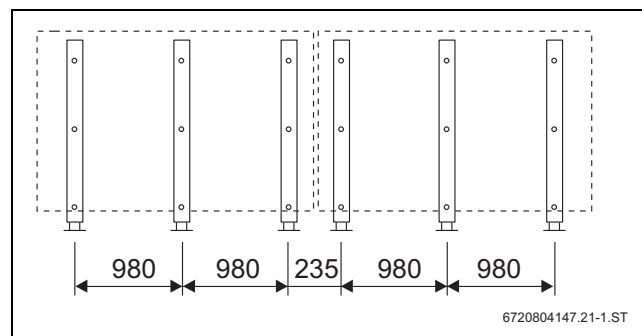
Ausführung für höhere Lasten, 2 waagerechte Kollektoren, Anstellwinkel 30° (Fußverankerung)
